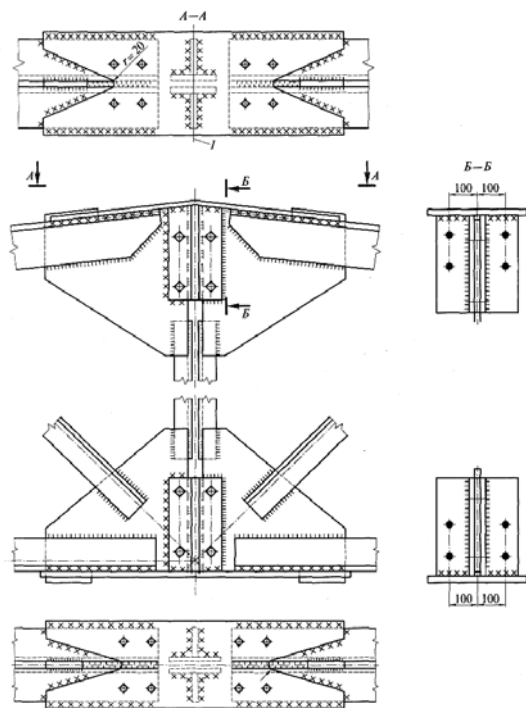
Укрупнительный стык стропильной фермы из парных уголков на сварке:
